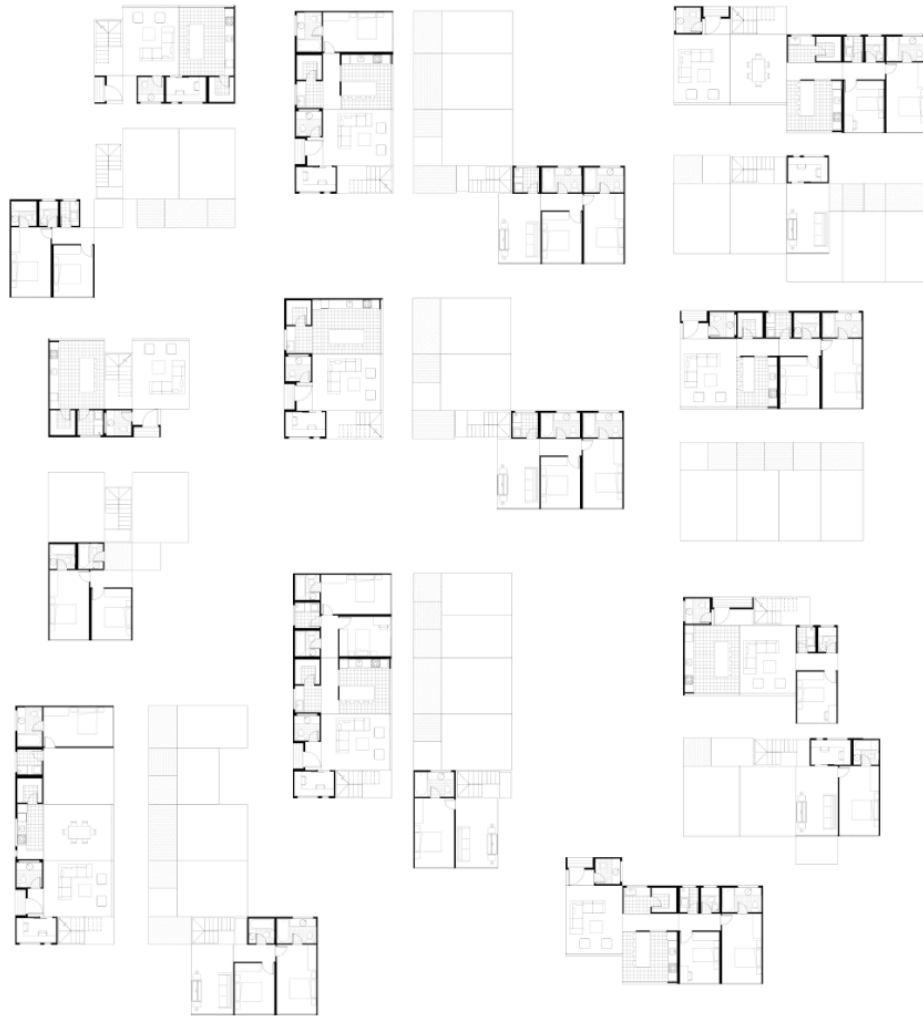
Plantas de vivienda posibles. Elaboración Propia.
